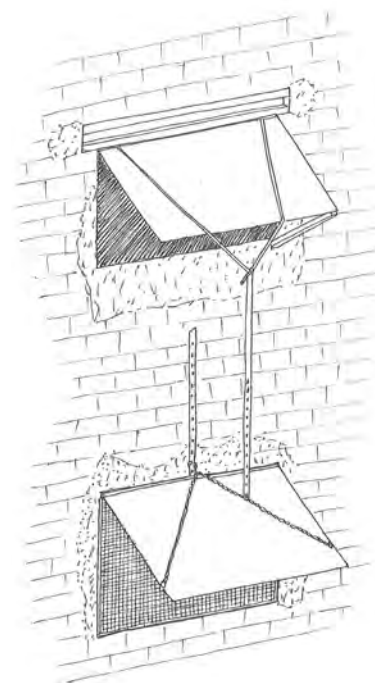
Detalle del sistema de regulación de caudal de aire en un secadero de cerramiento de bloque de hormigón.
